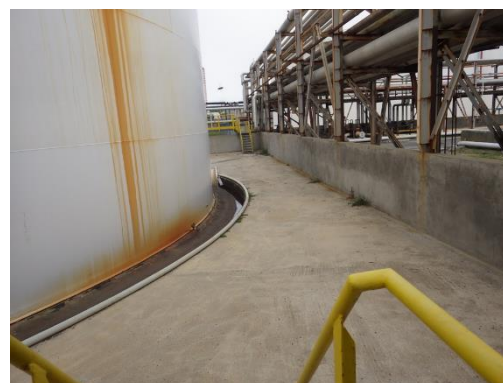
Bacino di contenimento con pavimentazione impermeabile
